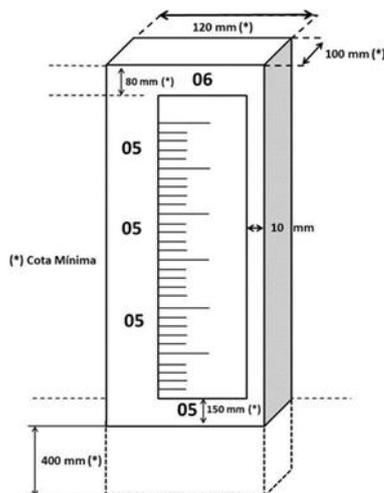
Esquema de identificação a ser aplicado aos mourões de suporte da régua limnimétrica mostrando as dimensões do corpo do mourão e a escala impressa.
